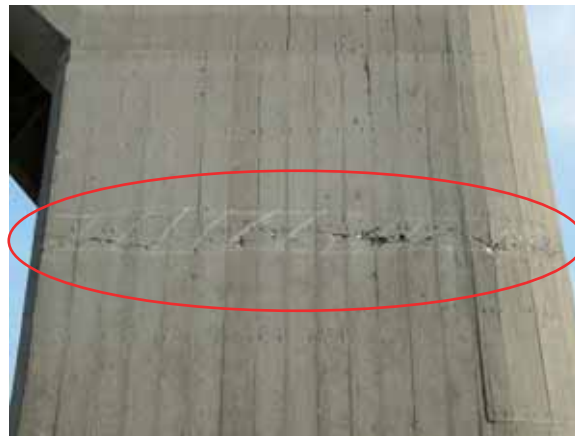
P1 橋脚中間部のひび割れ、コンクリートの剥離 (A1 側より)
